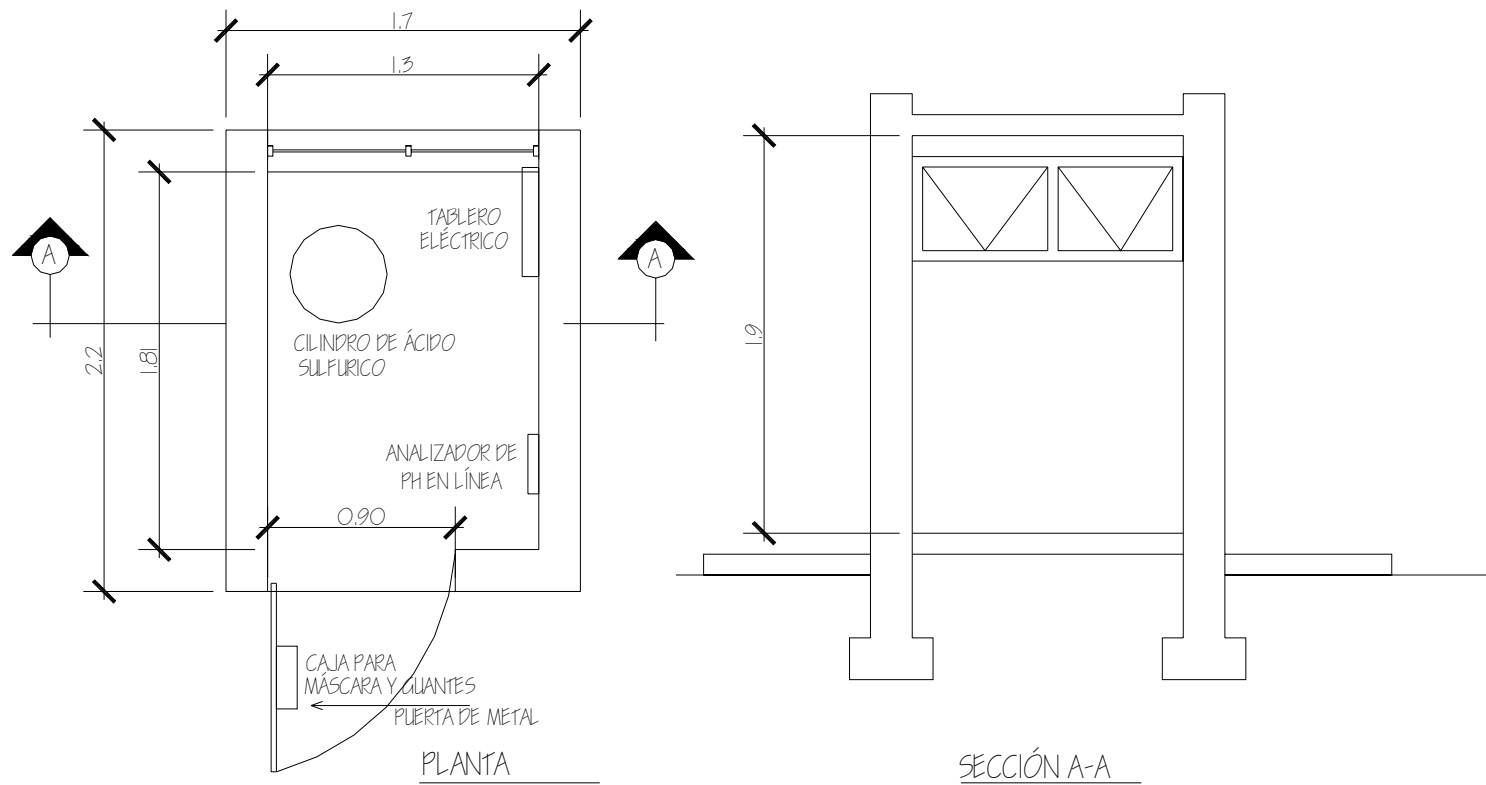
Planta y sección de caseta por construir para realizar el pretratamiento de estabilización de pH en las aguas provenientes de lavandería
